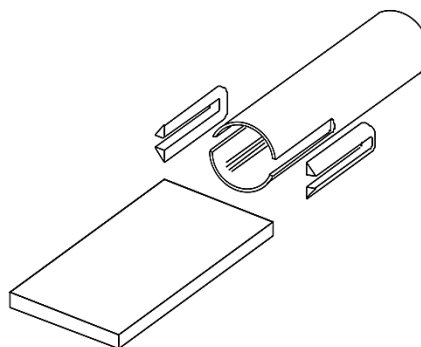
Ligação com rasgo no tubo e com soldaduras de retorno (Fonte: *Willibald et al., 2006*)
